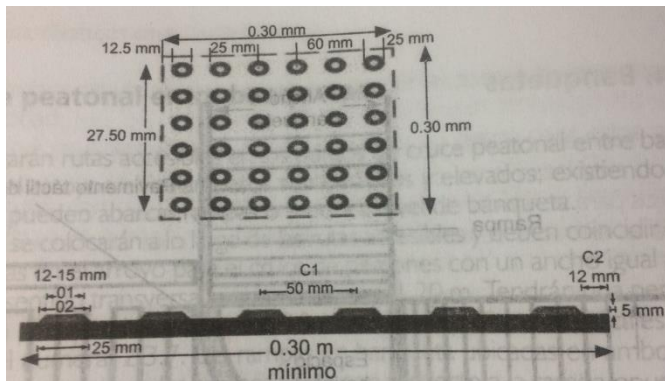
Pavimento de advertencia planta y corte (Fuente: Reglamento de construcción del Distrito Federal, 2017)
